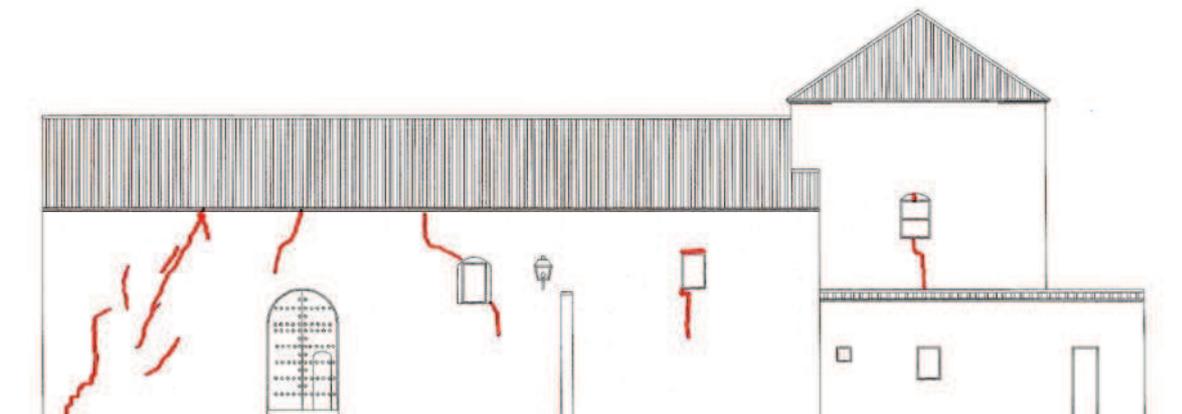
Levantamiento de daños en Alzado calle Mezquita
